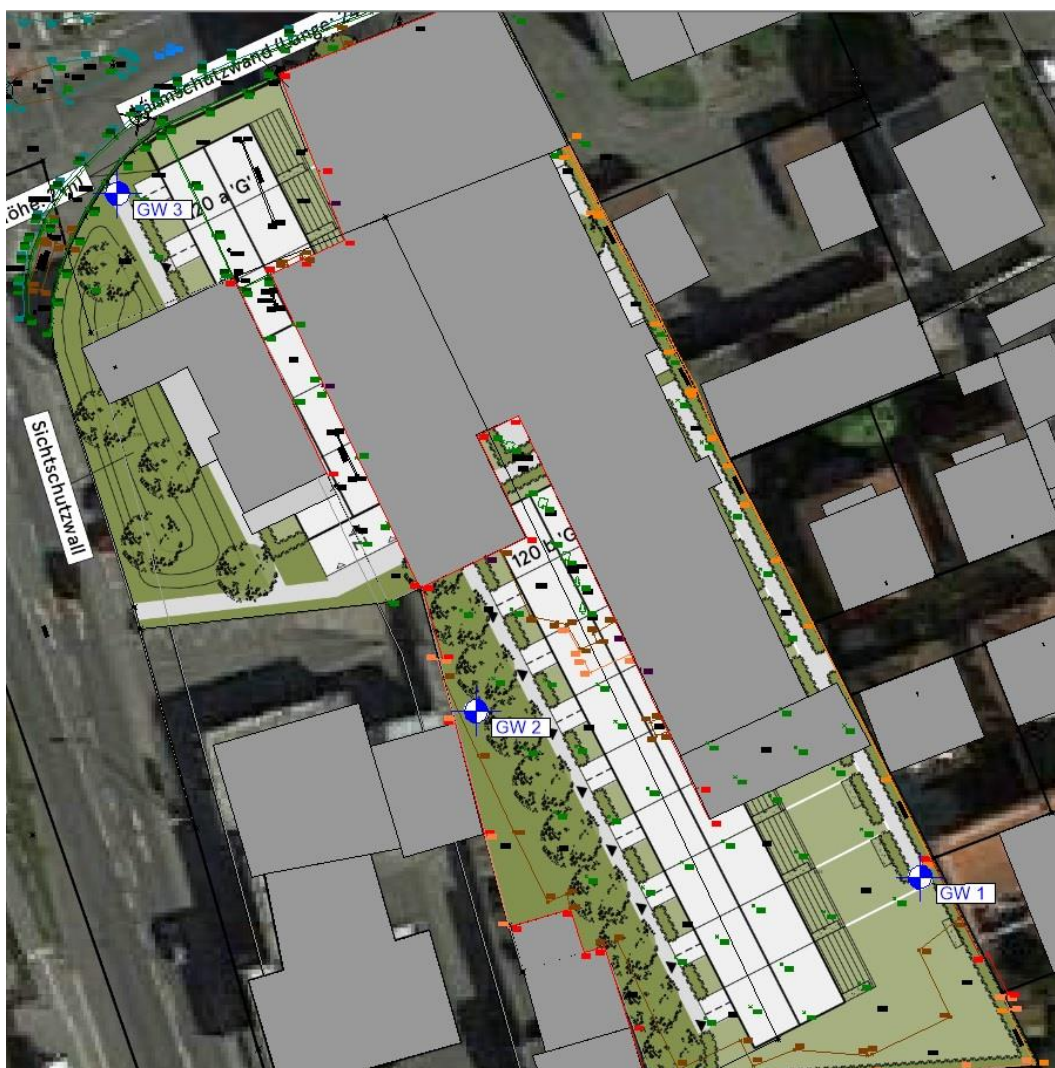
Luftbild mit Liegenschaftskarte [7] und Plan des Bauvorhabens [1] überlagert. Geplante Lager der Grundwassermessstellen (GW 1 bis GW 3) sind mit blauen Fadenkreuzen markiert.
